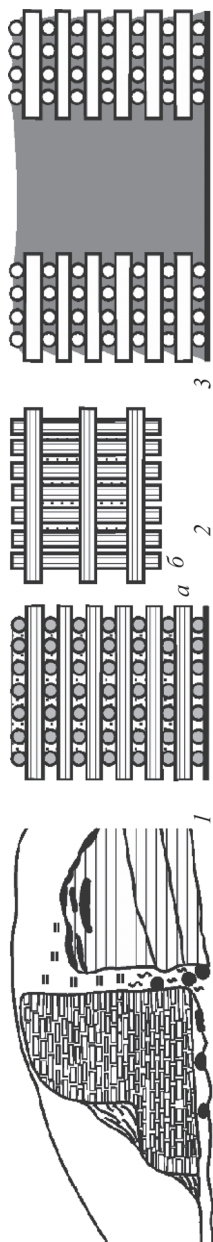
Понски новые решения киевских зодчих. 1 – Заречье: руины стены с лпцевой сырцовоной кладкой (по П. А. Раппопорту); 2 – однорядная стена крюкового строя (а – разрез; б – план); 3 – разрез двухрядной стены с внутренней засыпкой (по М. П. Кучере)
